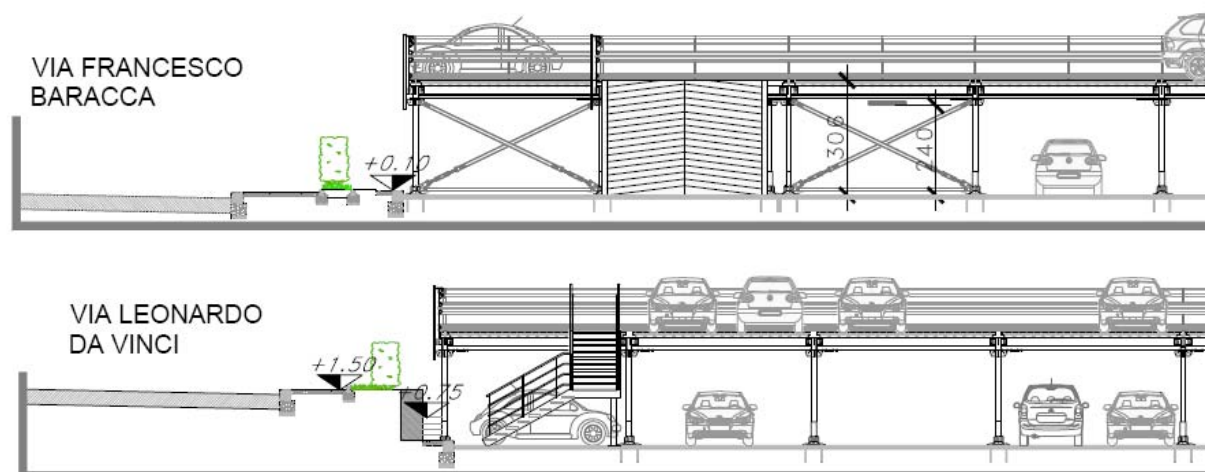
PARCHEGGIO MULTIPIANO MODULARE TIPO FAST PARK P5: DETTAGLI SEZIONE A-A' E SEZIONE B-B'
